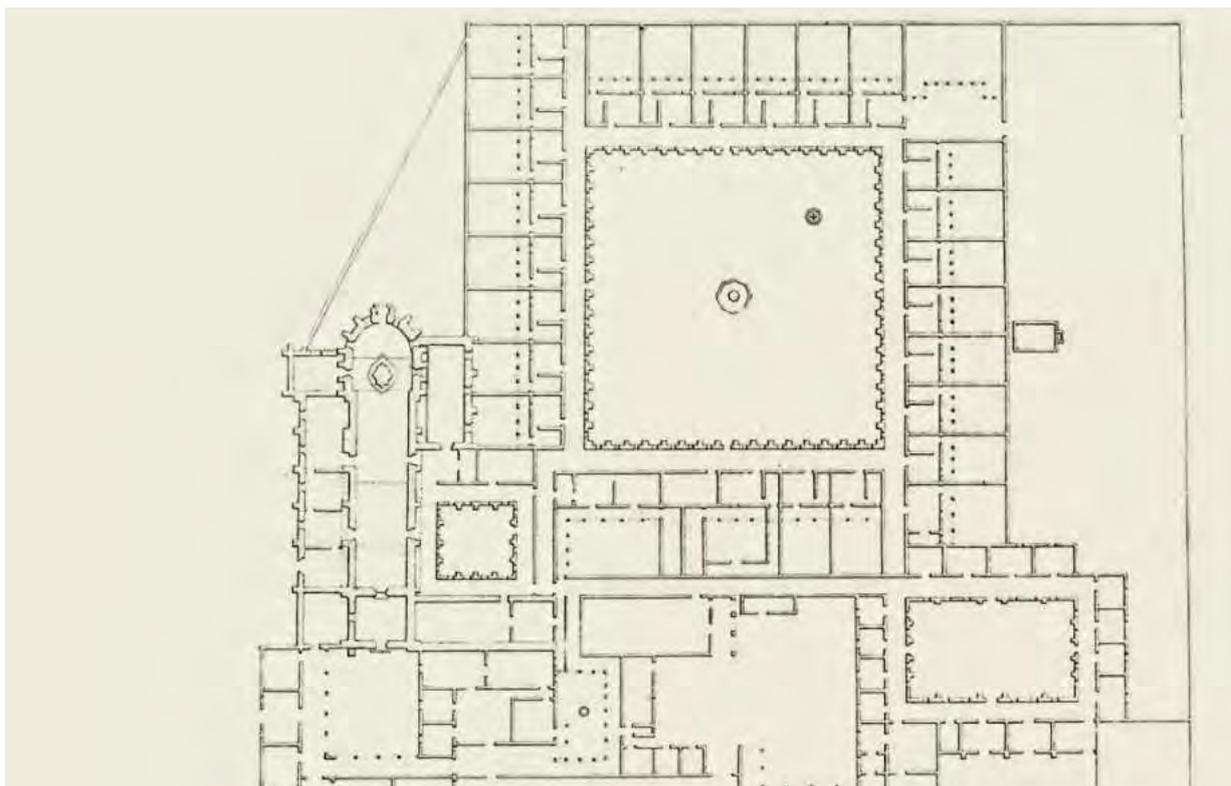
Planta Térrea do Convento da Cartuxa.
